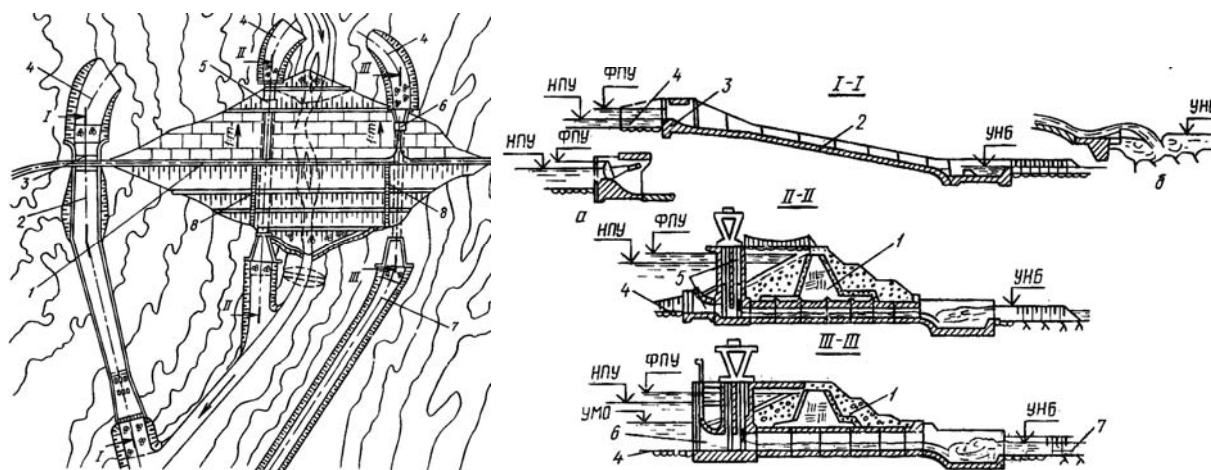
Гидроузел с грунтовой плотиной, береговым водосбросом-быстроотком, водовыпуском и водозабором на орошение:
